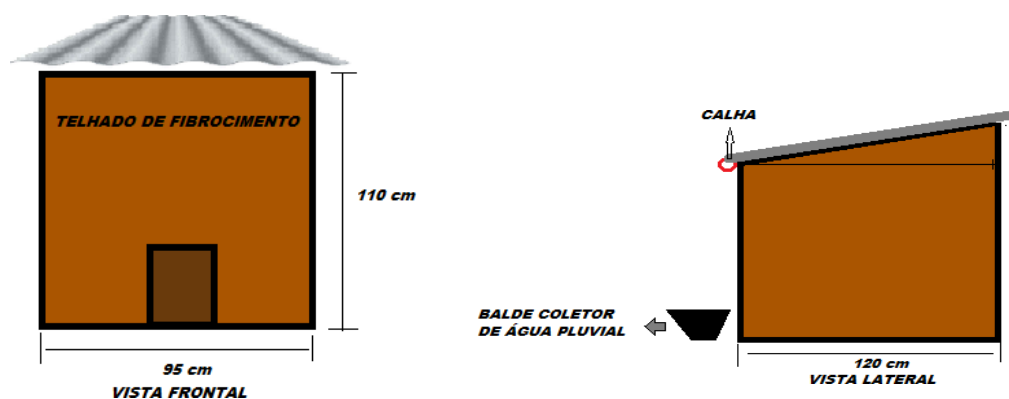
Componentes do telhado de fibrocimento e suas dimensões.
